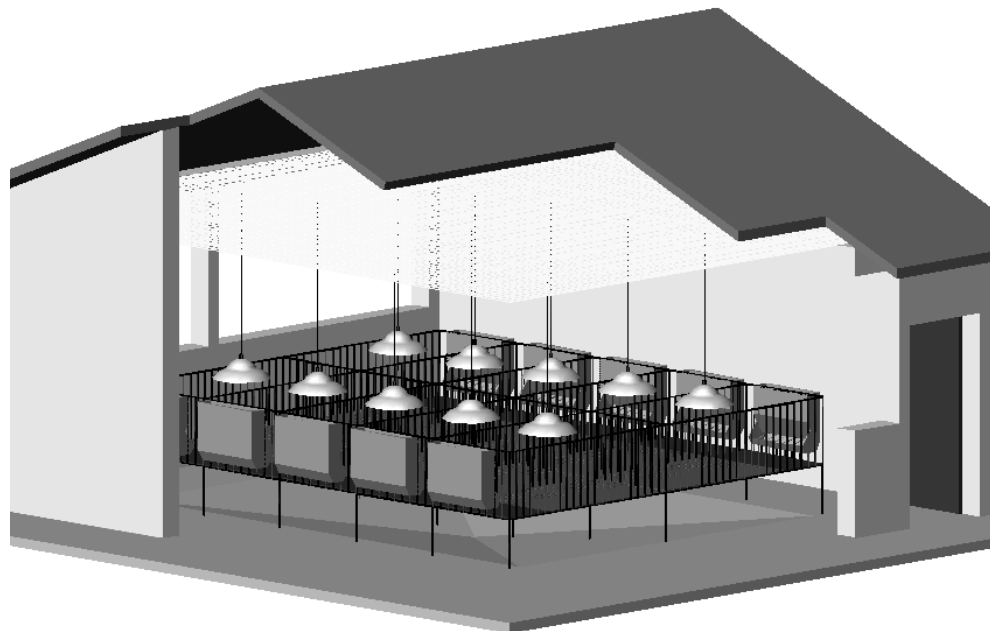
Vista em perspectiva de uma sala de creche com gaiolas elevadas
